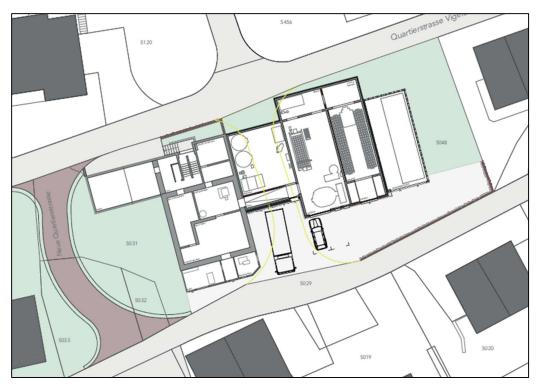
Situationsplan Vorprojekt Erweiterung Käserei.
